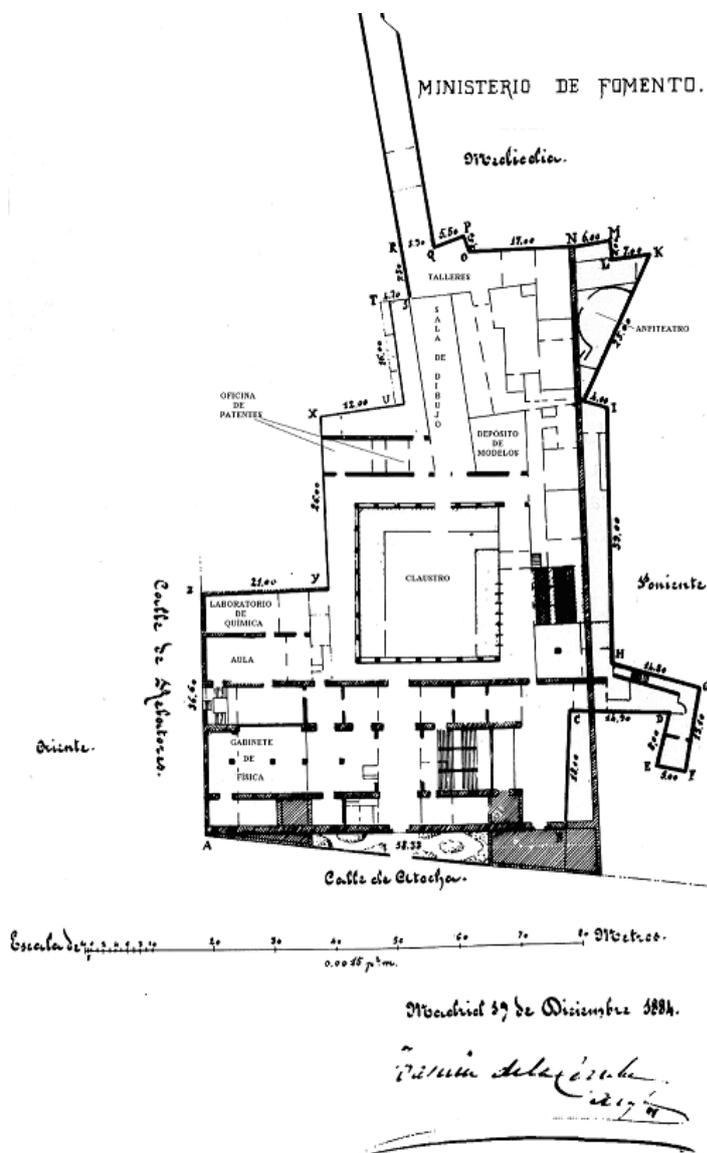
Reconstrucción de las dependencias del RCA sobre la planta baja del edificio de la Trinidad. (Elaboración propia a partir de un plano de Planta realizado por su arquitecto conservador Joaquín de la Concha en 1888 y un presupuesto de obras realizado en 1846 con motivo de su traslado desde la Calle del Turco. Fuente: Plano de planta (AGA-MEC, 9076.2) y Presupuesto de Obras (AGA-MEC, legajo EC6082).
